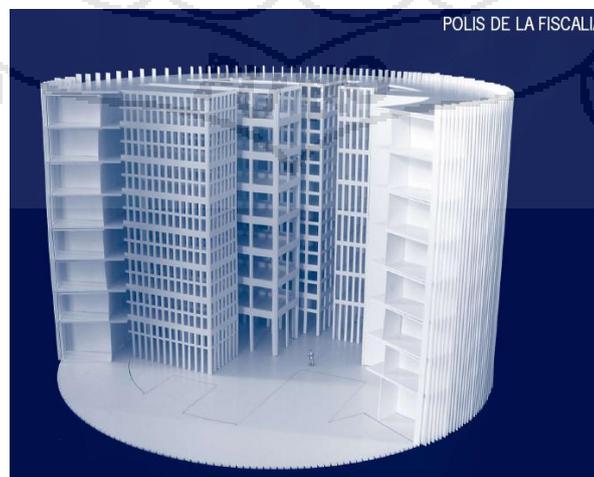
SE MUESTRA EL DETALLE DE LA ESTRUCTURA
